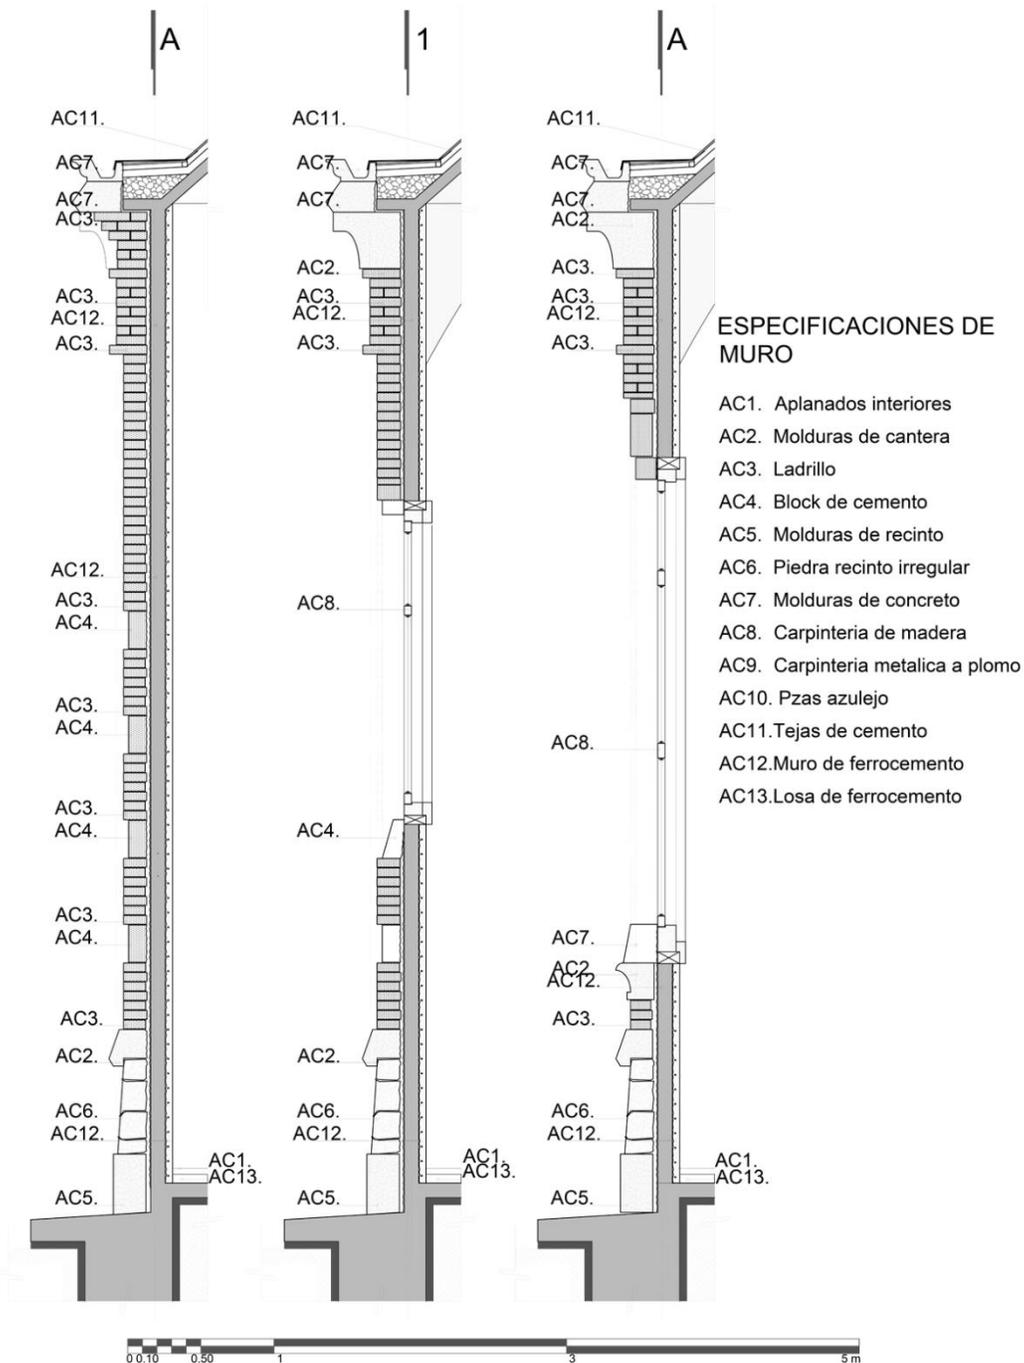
Euroza, Rocio. *Tres tipos de corte por fachada*. Febrero de 2021. El muro de escurrimiento perimetral llevó el canal recolector de las aguas pluviales, se compuso de: muro fabrica exterior; muro estructural y muro acabado interior. En la fábrica, el monumento retomó la composición estética ecléctica. El seccionamiento señalado permitió la seriación y la composición constructiva de los elementos.
